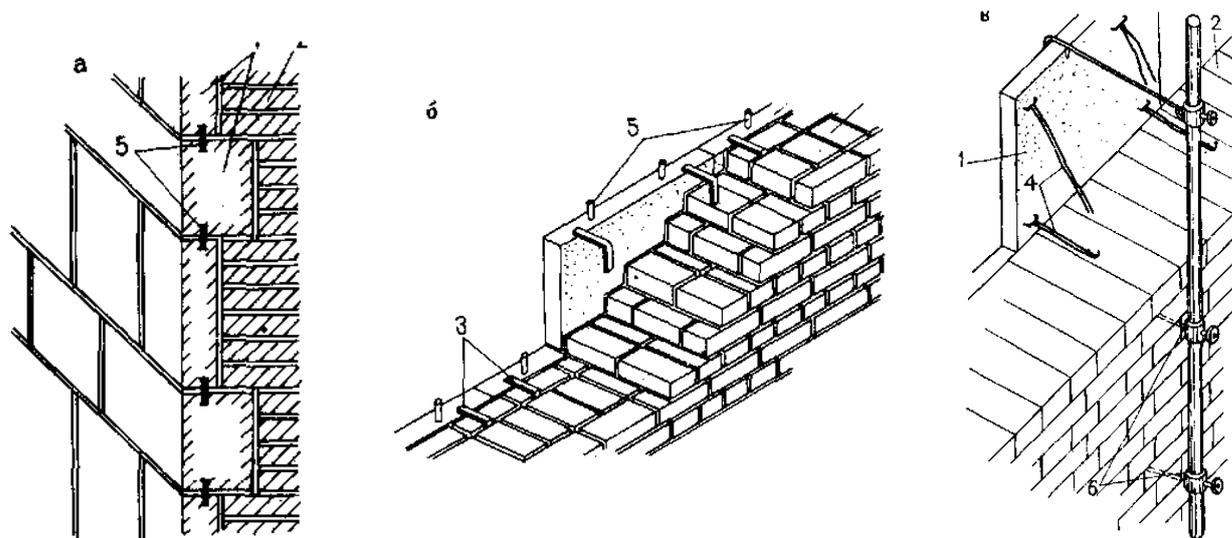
Устройство облицовки наружных стен одновременно с ведением кладки : а – в перевязку с кладкой; б – с жестким креплением к кладке; в – приспособление для временного закрепления плит; 1 – облицовка; 2 – кладка; 3 – детали жестких креплений для ведения облицовки природным камнем одновременно с кладкой; 4 – то же, искусственными декоративными плитами; 5 – пироны; 6 – приспособление для временного закрепления плит облицовки.
